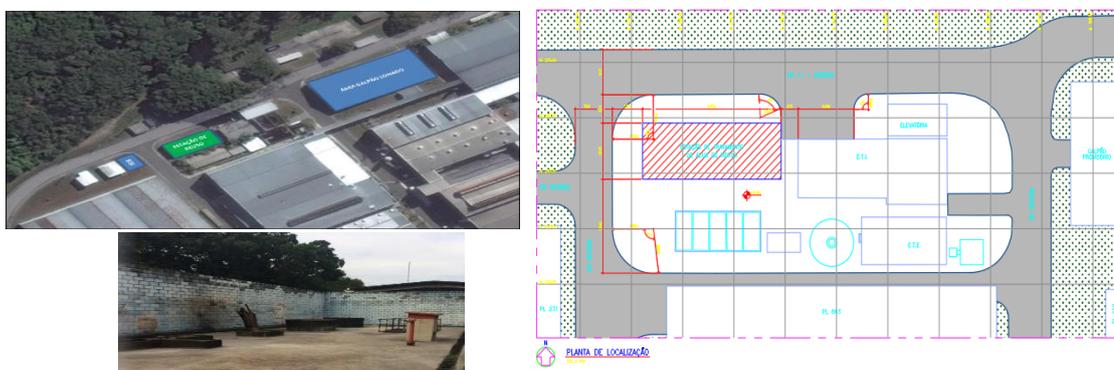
Vista do local proposto pelo Projeto e estudo do layout.
